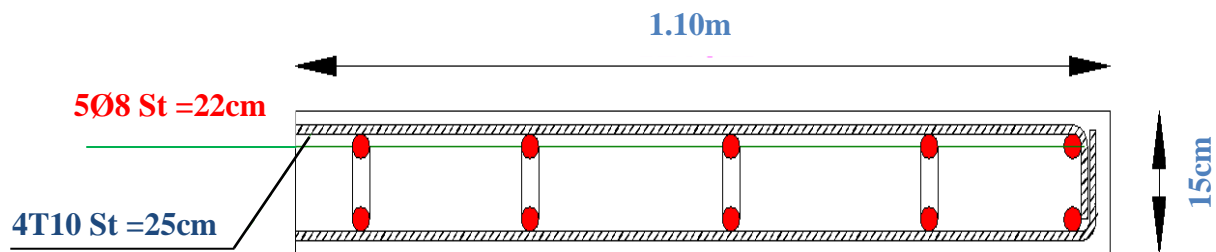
Dessin de ferrailage (balcon type 01)
